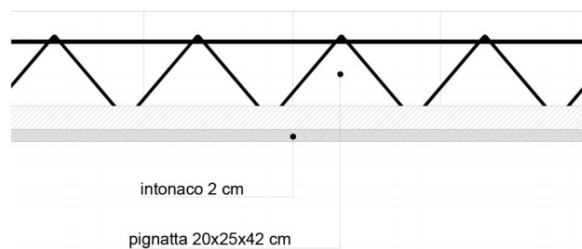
Sezione tipologica del terzo solaio (Pegoraro, 2021).
